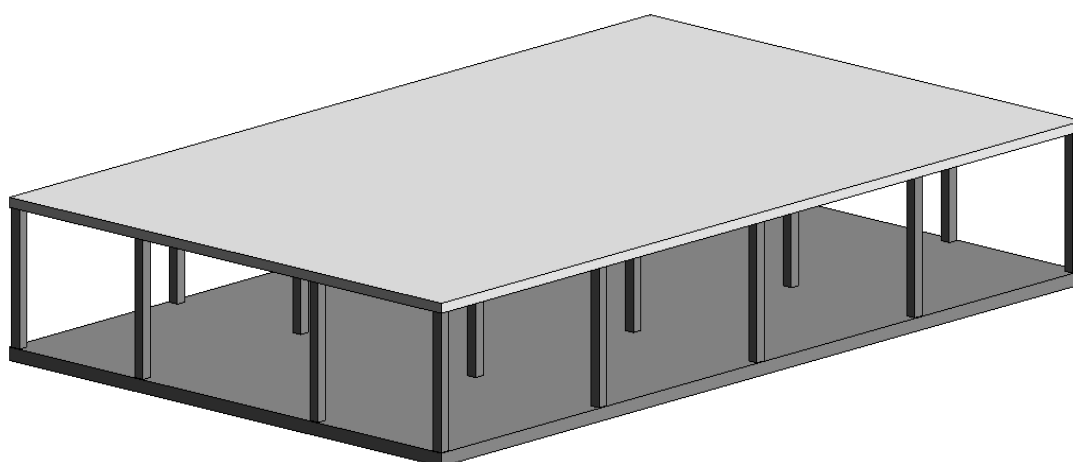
Modelo de la estructura de estacion de FFCC en revit
